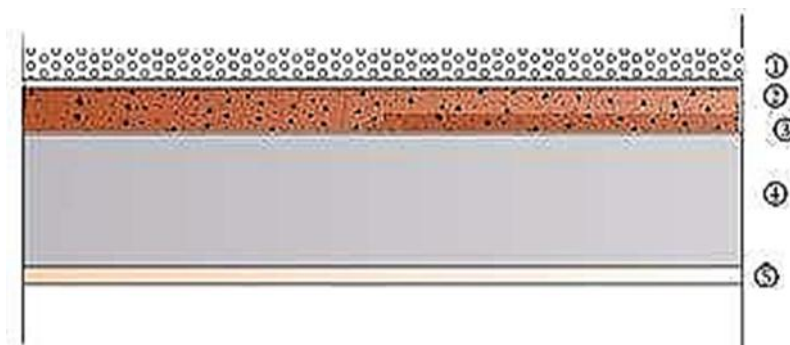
Coupe transversale d'un balcon en dalle pleine.
